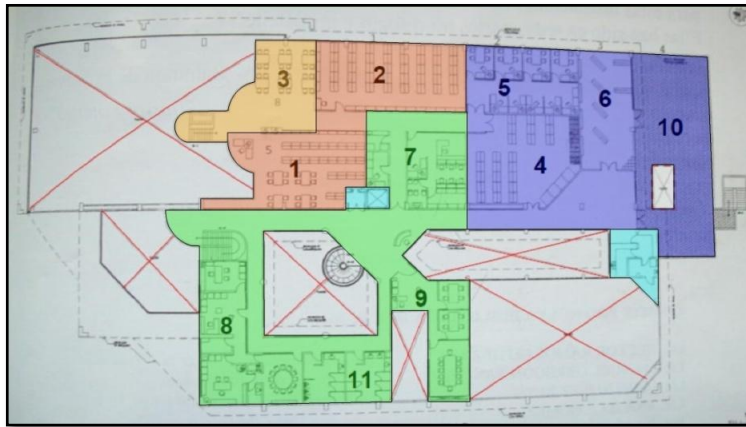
Planta Arquitectónica Segundo Nivel
